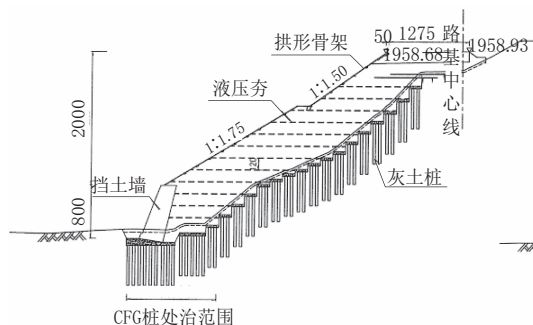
新旧路基处理 ZK61+900 施工横断面(单位:cm)
